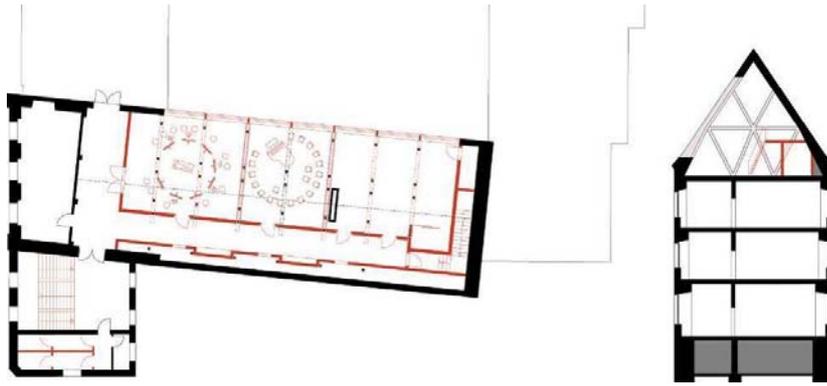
Grundriss, Schnitt, Piktogramm: Dachgeschoß Josephinum
